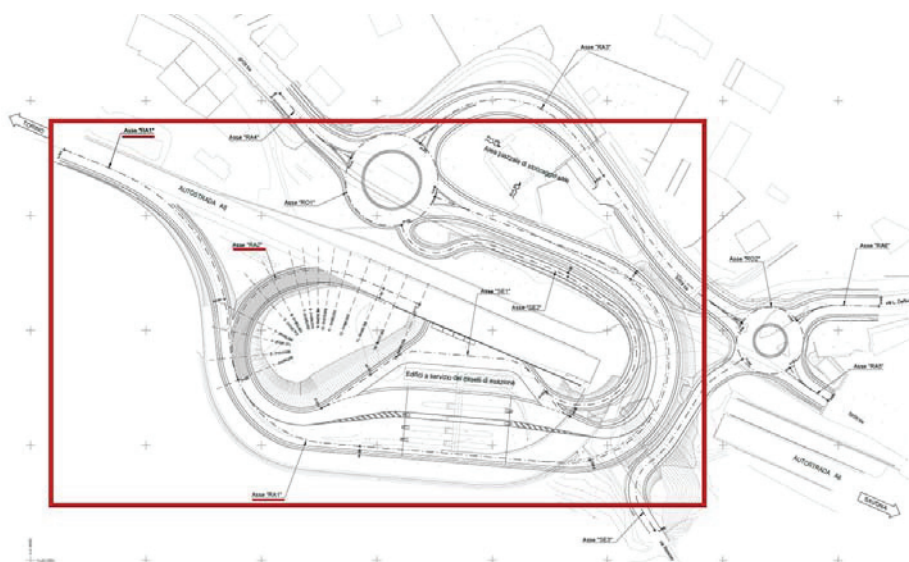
Planimetria generale ASSE RA1 e RA2
